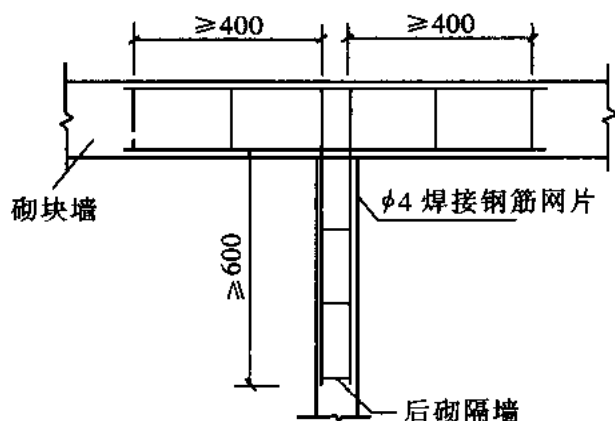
砌块墙与后砌隔墙交接处钢筋网片
